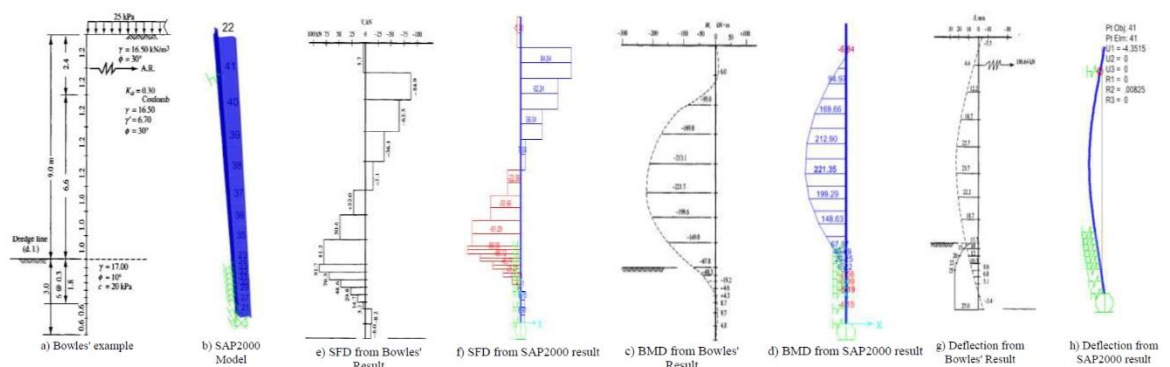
Moment/forflytning/fordeling av krefter til ANCHORED SHEET PILE QUAY WALL
